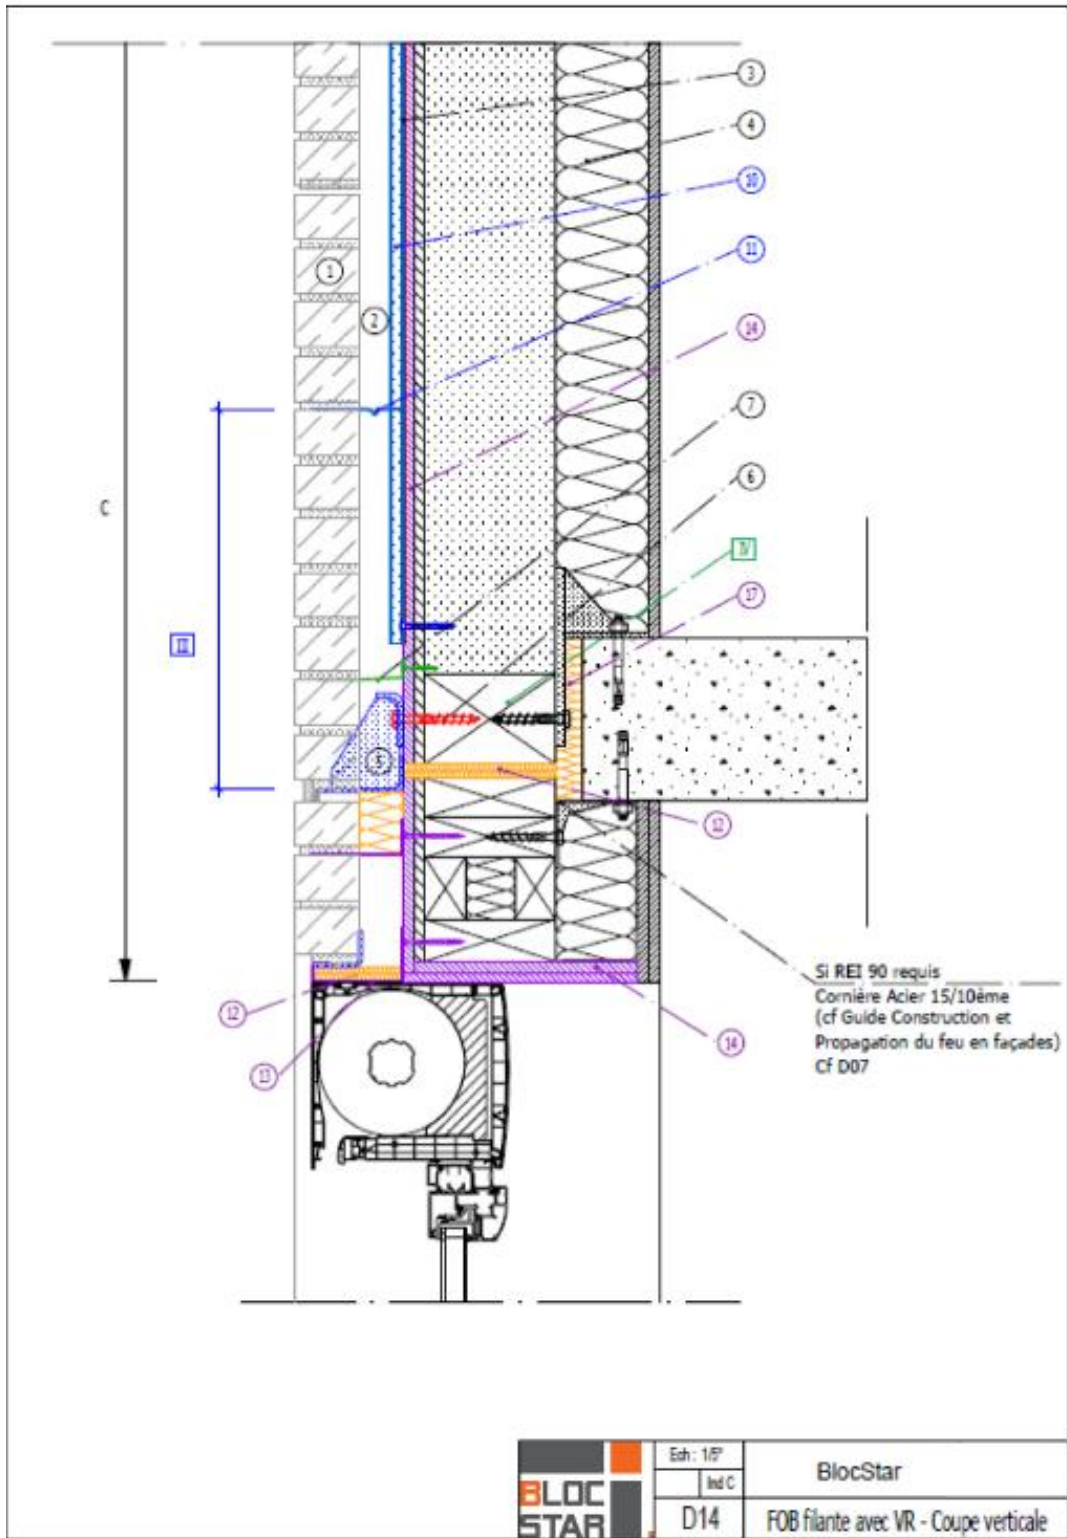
Traitement des embrasures – coupe verticale en linteau (FOB filante avec CVR)
